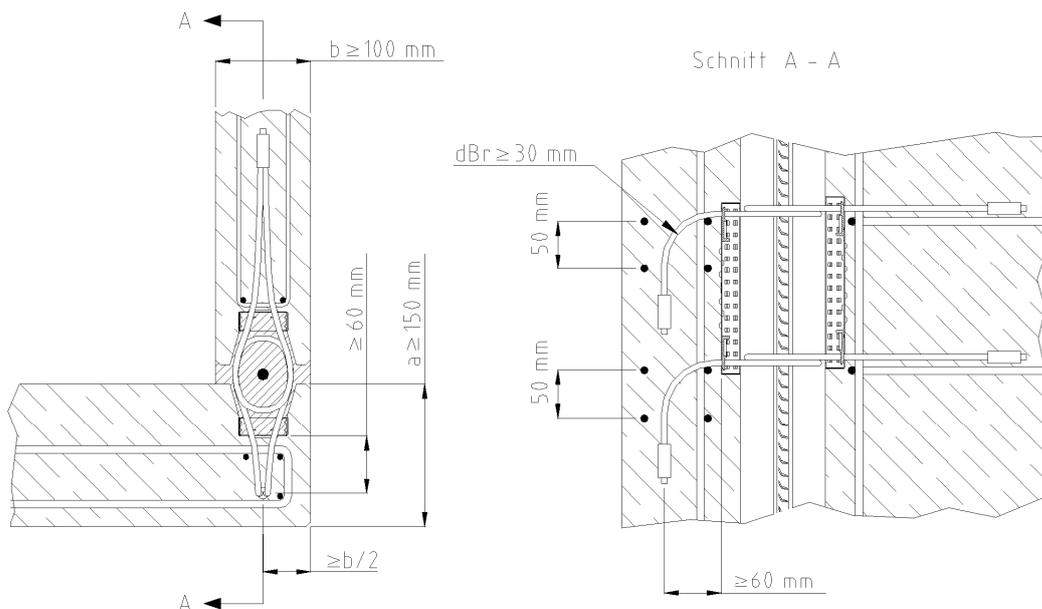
Wand – Wand – Eckverbindung - Detail mit abgewinkelten Seilschlaufen
